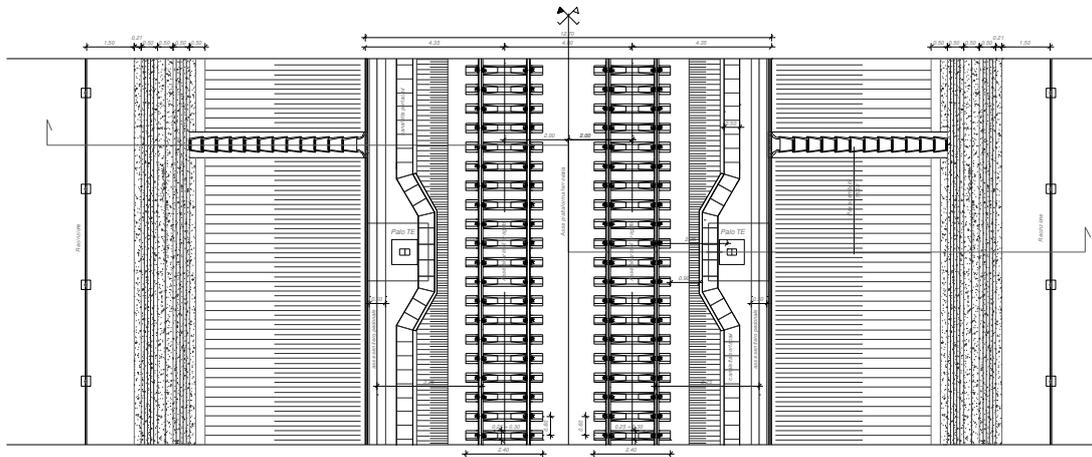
Stralcio planimetrico per sezione tipo ferroviaria in rilevato a doppio binario (piattaforma in retto) con $H_{ni} \leq 6,00$ m
